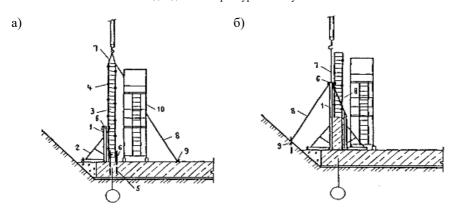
Технологическая схема производства опалубочных, арматурных и бетонных работ на стройплощадке:
